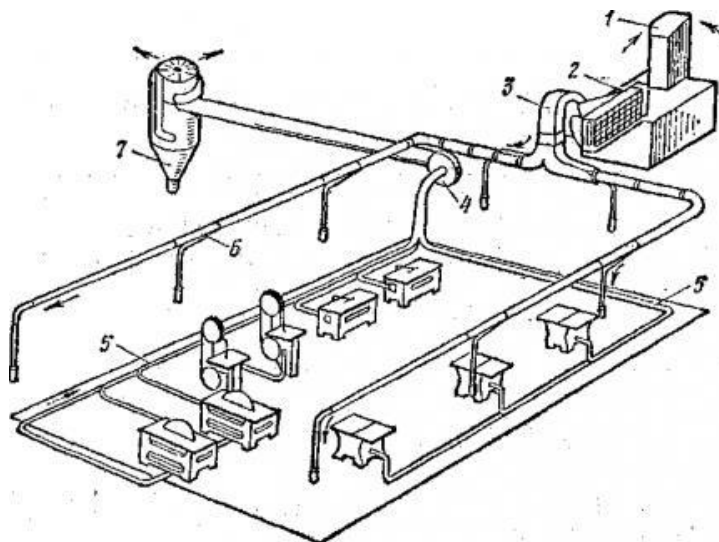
Схема механической вентиляции: 1 – воздухозаборная шахта, 2 – калорифер, 3 – подача воздуха, 4 – вытяжной вентилятор, 5 – воздуховоды вытяжной вентустановки, 6 – вентканалы, 7 – циклон
